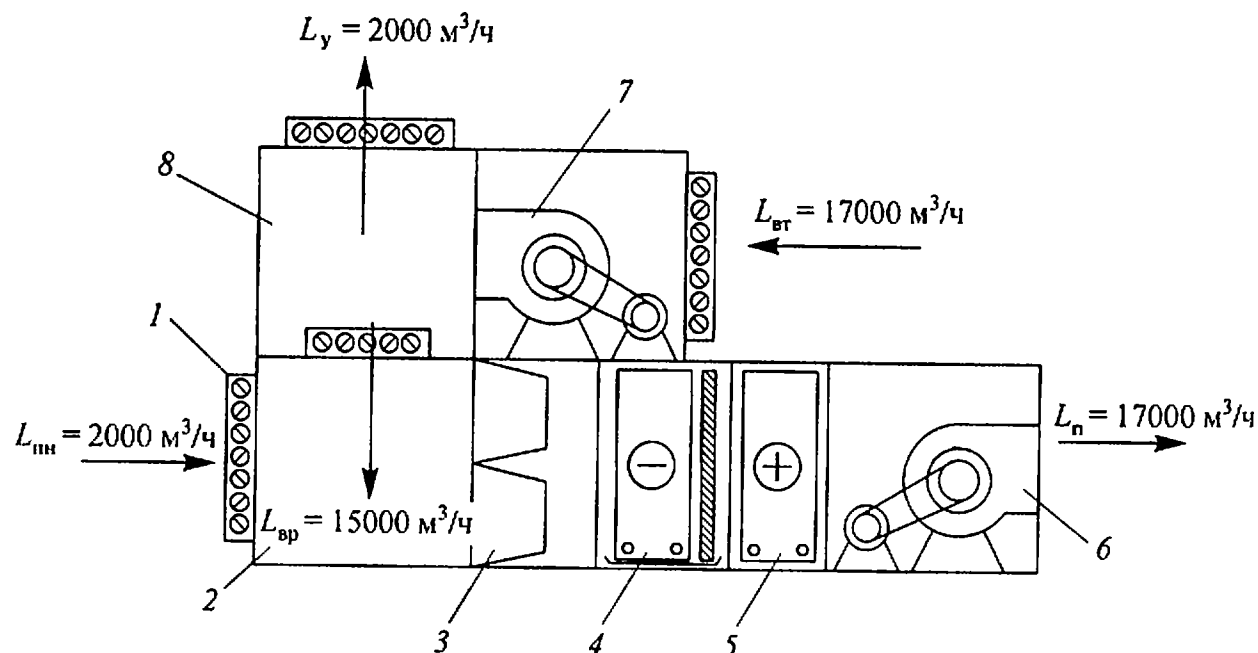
Принципиальная схема приточно-вытяжного агрегата для СКВ обслуживания ледяного поля: 1 — клапан забора наружного воздуха; 2 — смесительная камера; 3 — карманный фильтр; 4 — воздухоохладитель с сепаратором; 5 — калорифер; 6 — приточный вентилятор; 7 — вытяжной вентилятор; 8 — камера разделения рециркуляционного $L_{вр}$ и выбросного $L_{в}$ воздуха
